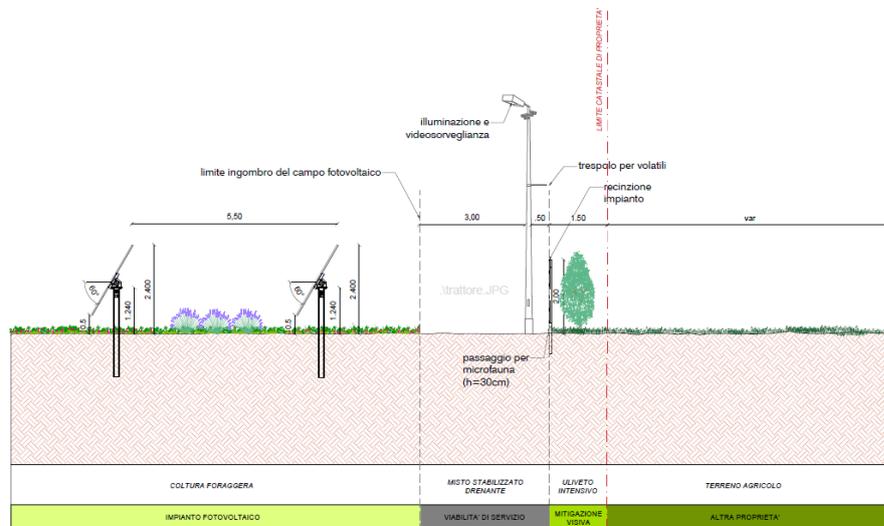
Sezione 1_Prospetto fascia di mitigazione lungo il perimetro dell'impianto
